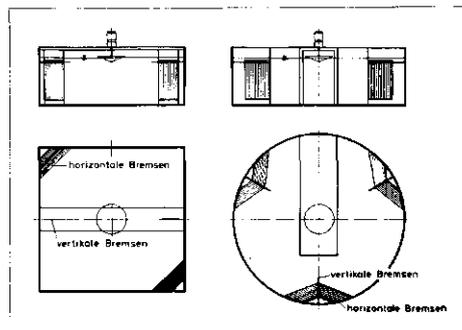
Vertikale und horizontale Bremsen im Belüftungsbecken.
